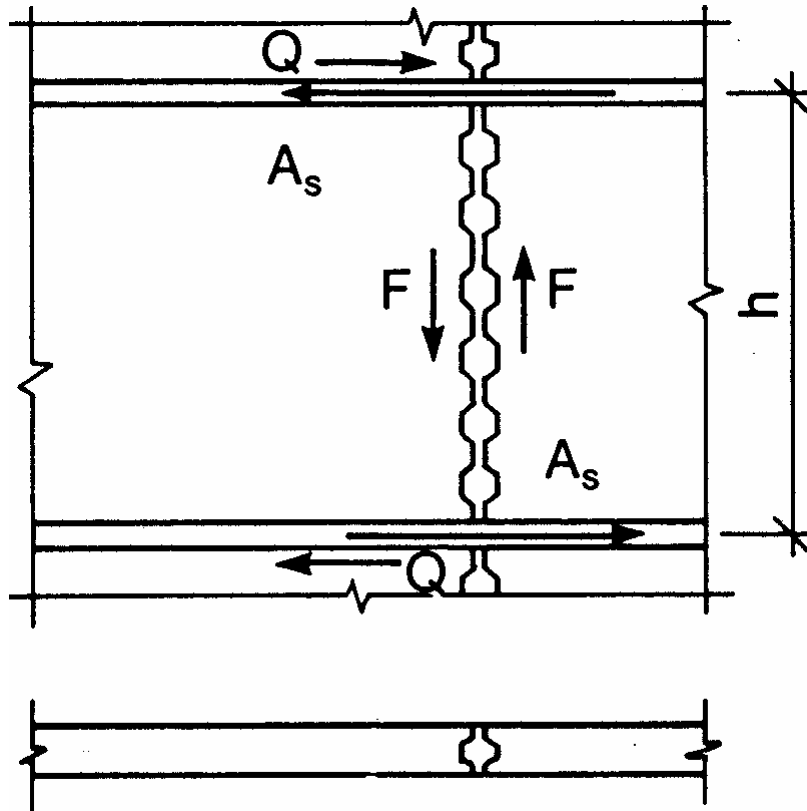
Ligações nas juntas de cisalhamento vertical entre elementos de parede
